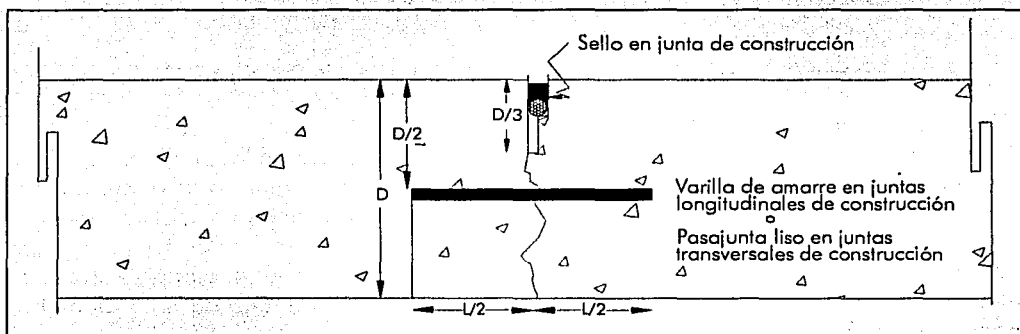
Sellado para juntas del pavimento de concreto hidráulico.
